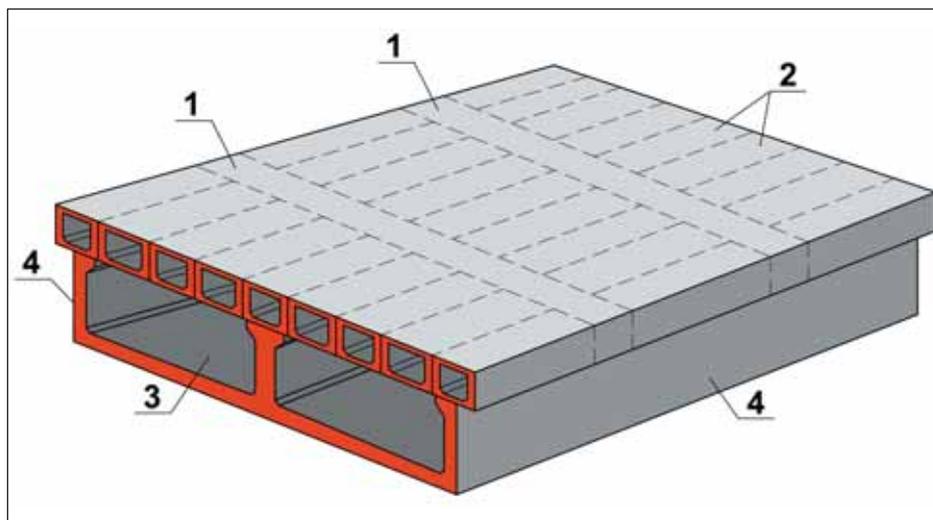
Конструкция участка Балтийского тоннеля в зоне пересечения с тоннелями метрополитена: 1 – поперечные прямоугольные балки перекрытия; 2 – продольные коробчатые конструкции перекрытия; 3 – лотковая плита тоннельной обделки; 4 – стены тоннельной обделки
